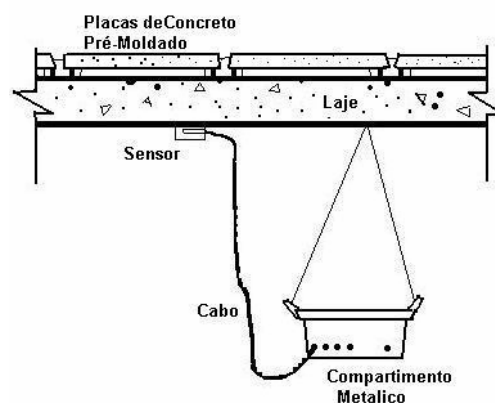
Croqui de Instalação do Equipamento na laje LC.
